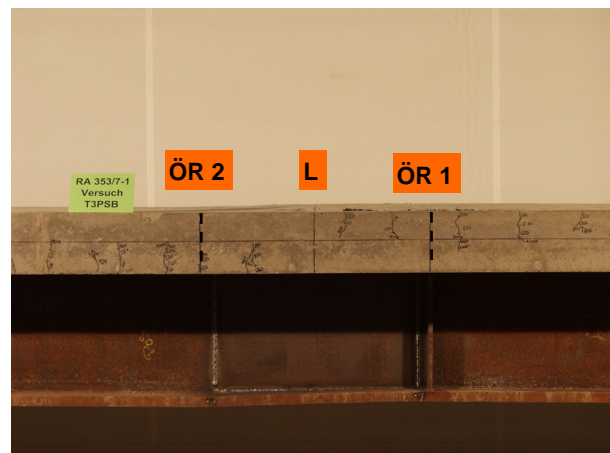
Rissbild auf der linken Betongurtseite
